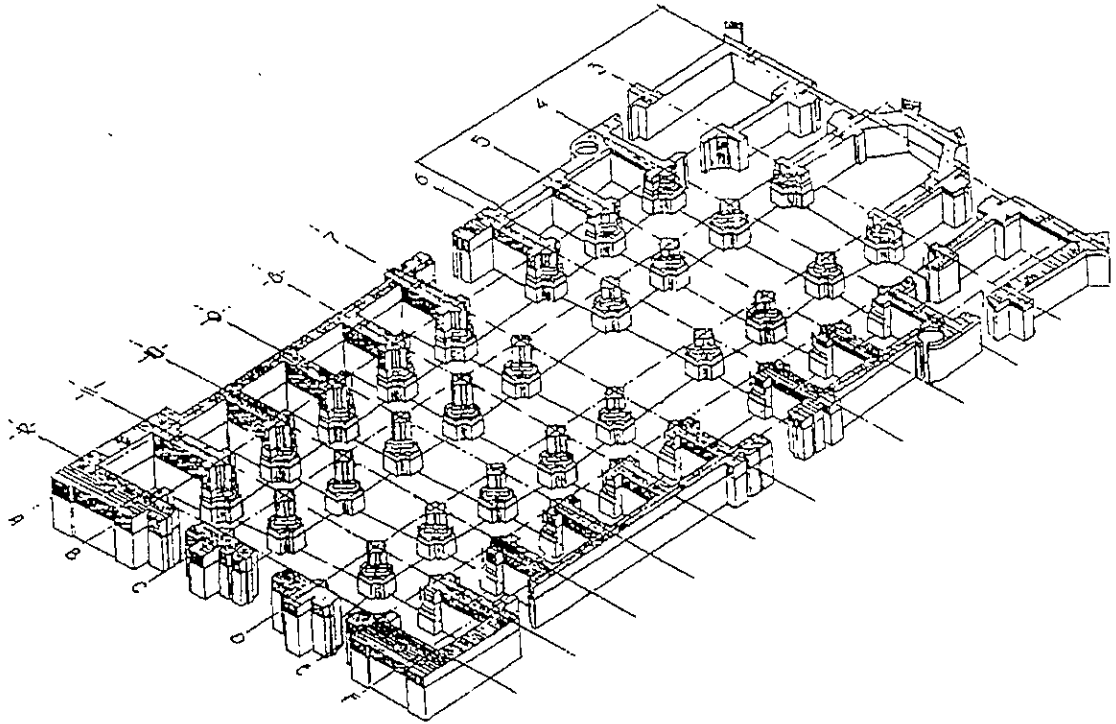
69. Incrementos de Fustes y muros durante el proceso de construcción 1573 – 1667
